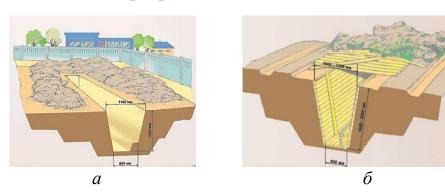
Щель для укрытия: а – открытая; б – перекрытая
